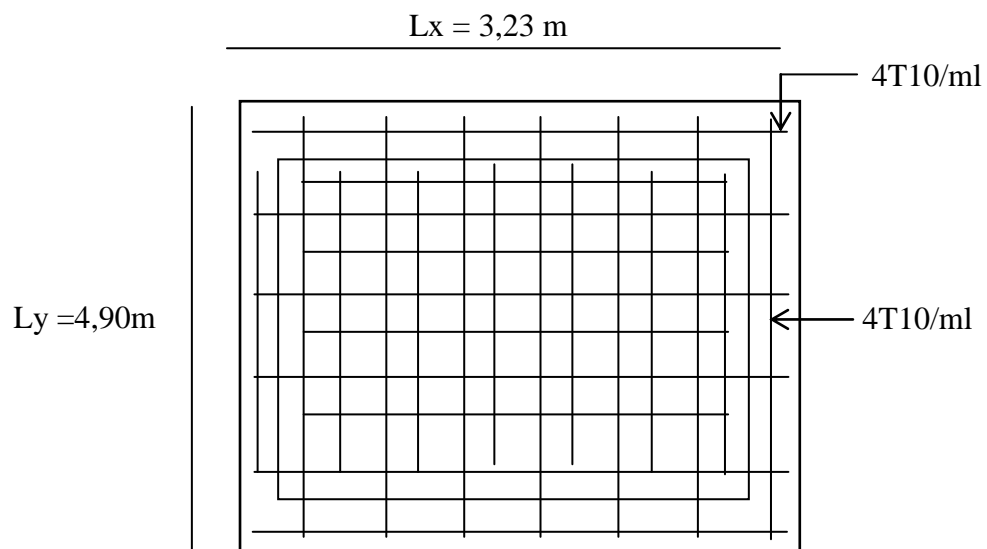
Dessin Ferrailage inférieur du panneau de la dalle pleine.
